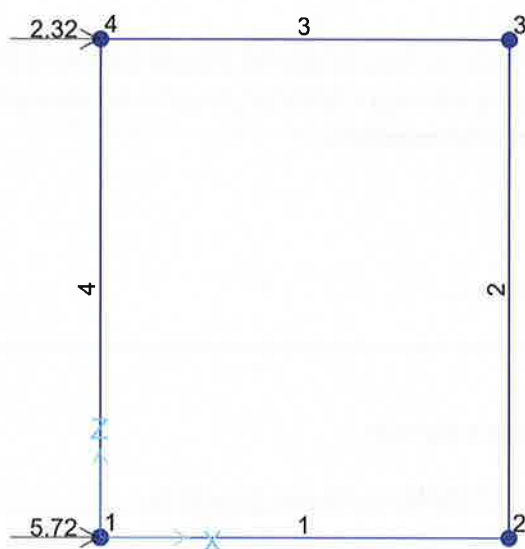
CARICO DISTRIBUITO DOVUTO ALLA SPINTA DEL TERRENO (SPTSX)
